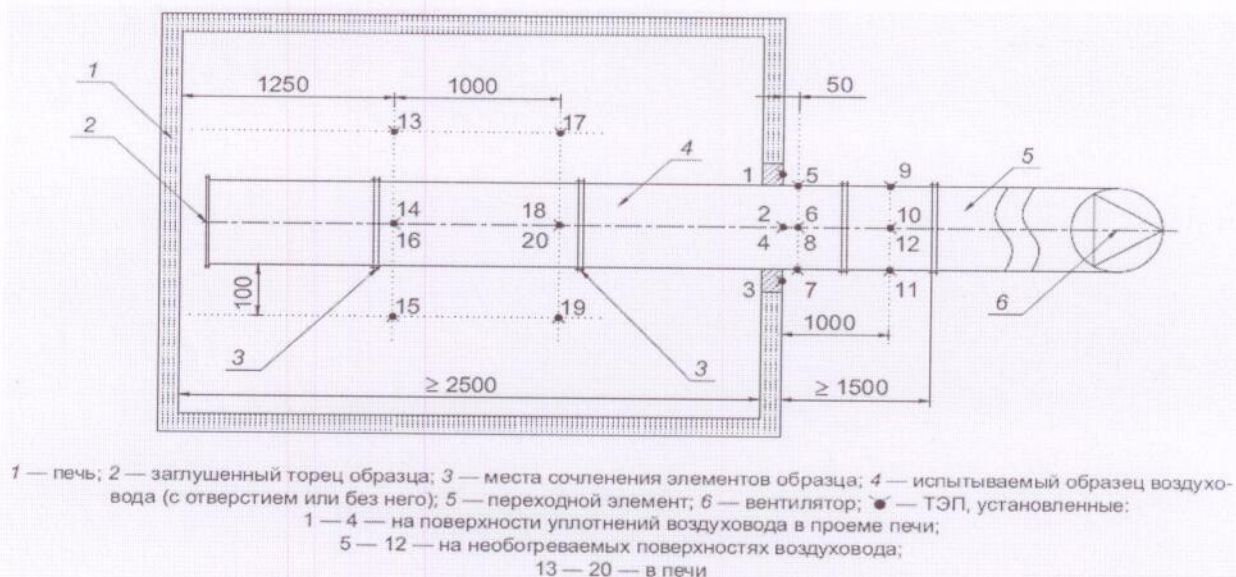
Схема размещения воздуховода на испытательном стенде.
